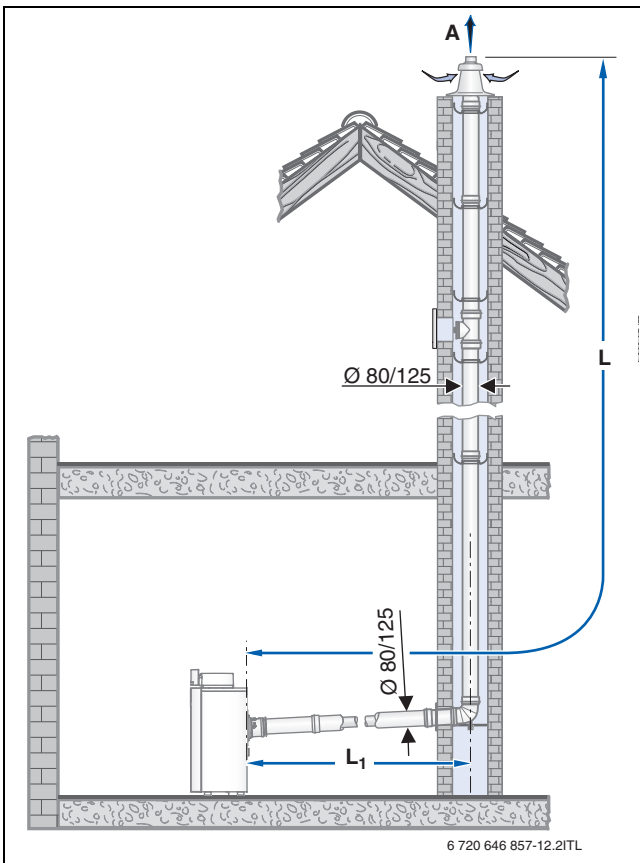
Variantes de montaje con el kit de montaje DO-S
